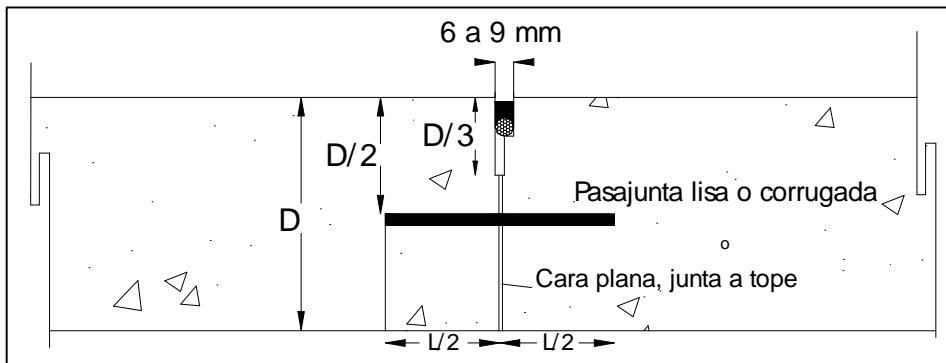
Junta transversal de construcción con pasajunta lisa o corrugada.
